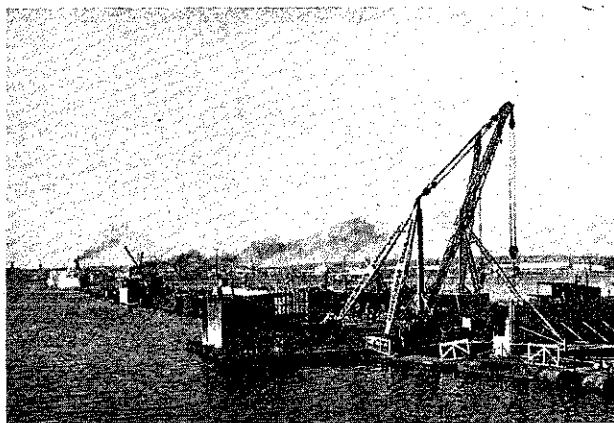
Port de Lavéra : Vue générale du chantier môle n° 1 depuis l'enracinement
